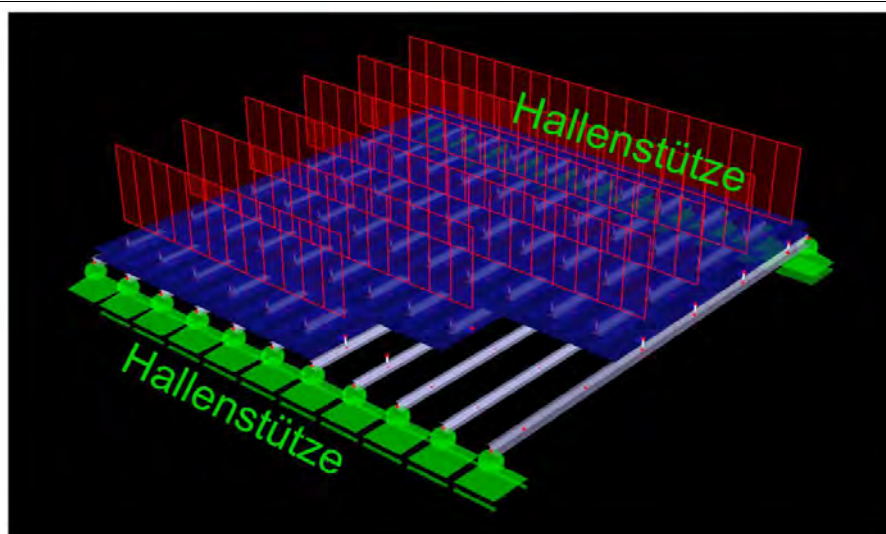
Stabwerksmodell Fassadenabschnitt 6000 x 6000 mm
